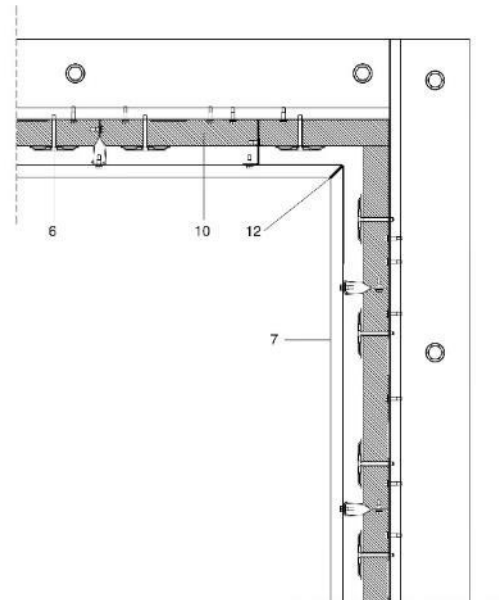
b: Detalle de esquina entrante (rincón) con aislamiento térmico.
